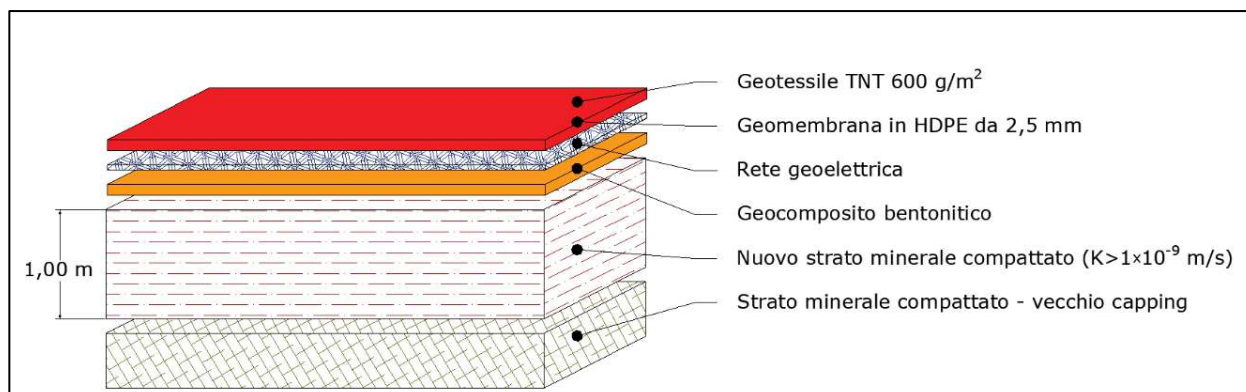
/XIII: Particolare pacchetto impermeabilizzazione superficie a ridosso dell'argine
